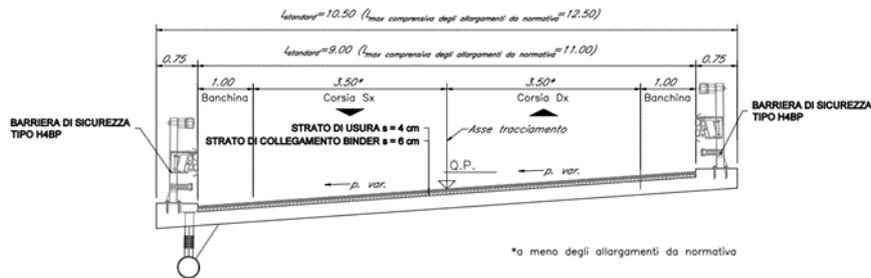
Sezione Tipo Bidirezionale in viadotto
